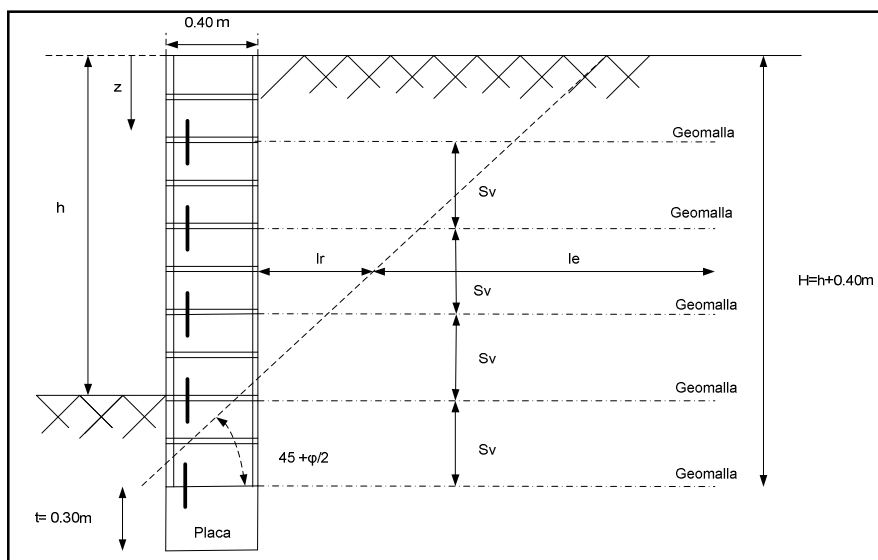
Esquema general muro de retención de mampostería con suelo reforzado
